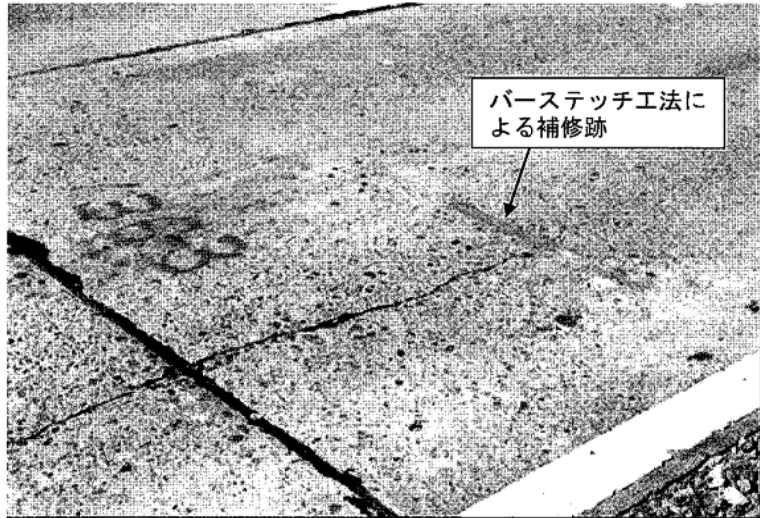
破損の種別：普通コンクリート舗装の縦ひび割れ	破損の程度：M
